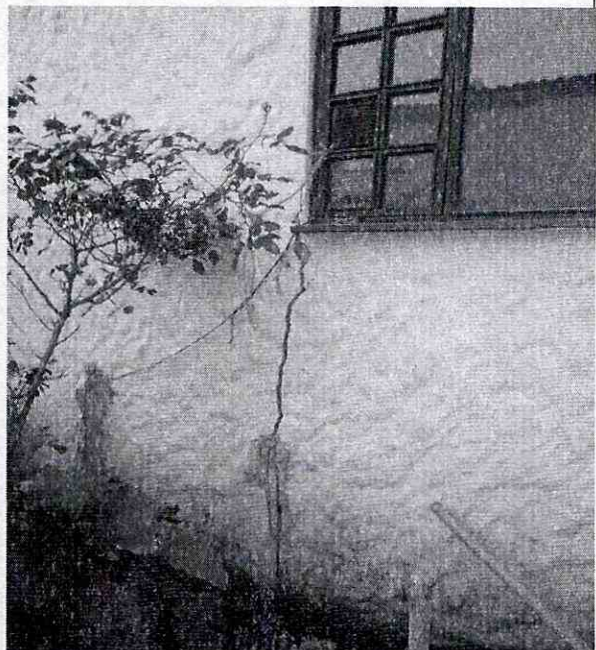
Al exterior de la vivienda se pueden observar fisuras y grietas de hasta 10 milímetros de abertura.
